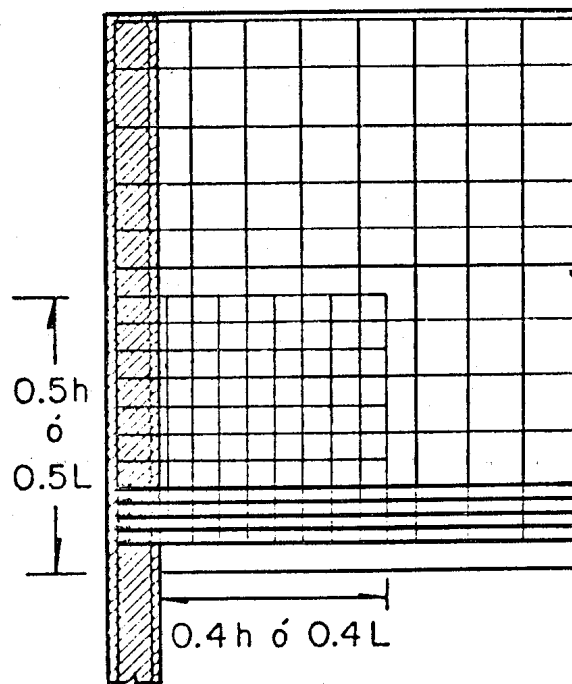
Refuerzo en una zona de apoyo indirecto.
